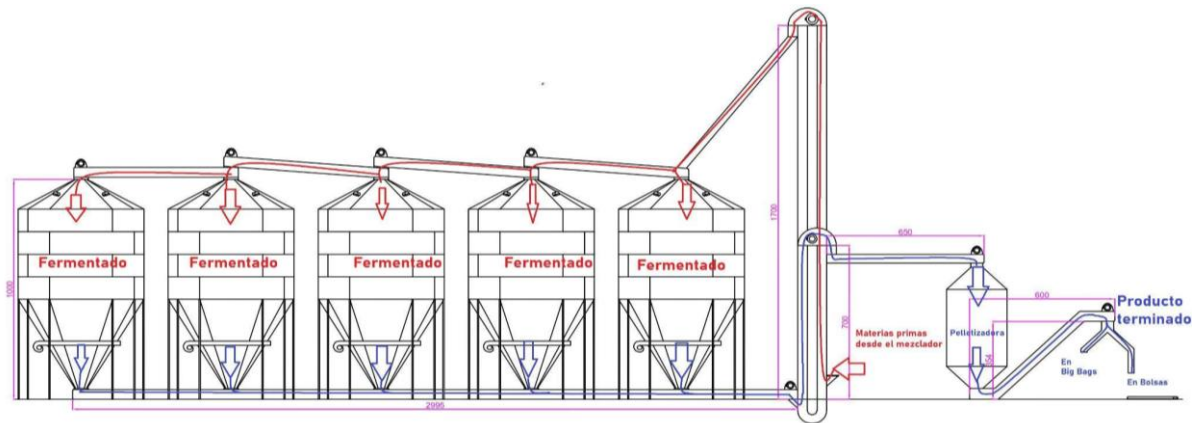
Vista lateral de la planta de silos con sus conexiones (cm). Fuente: Propia.
